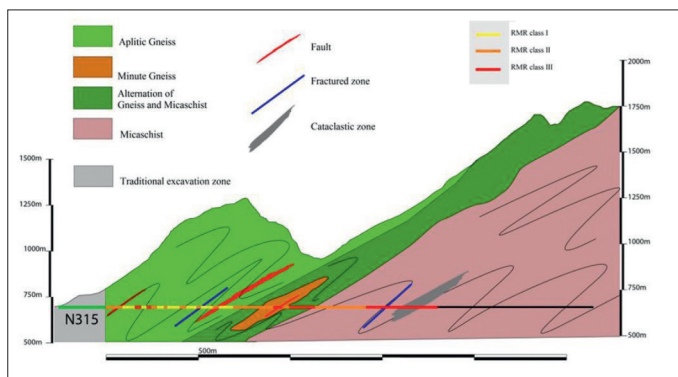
Sezione geologica longitudinale del tunnel de "La Maddalena" (Armetti et al, 2018).
